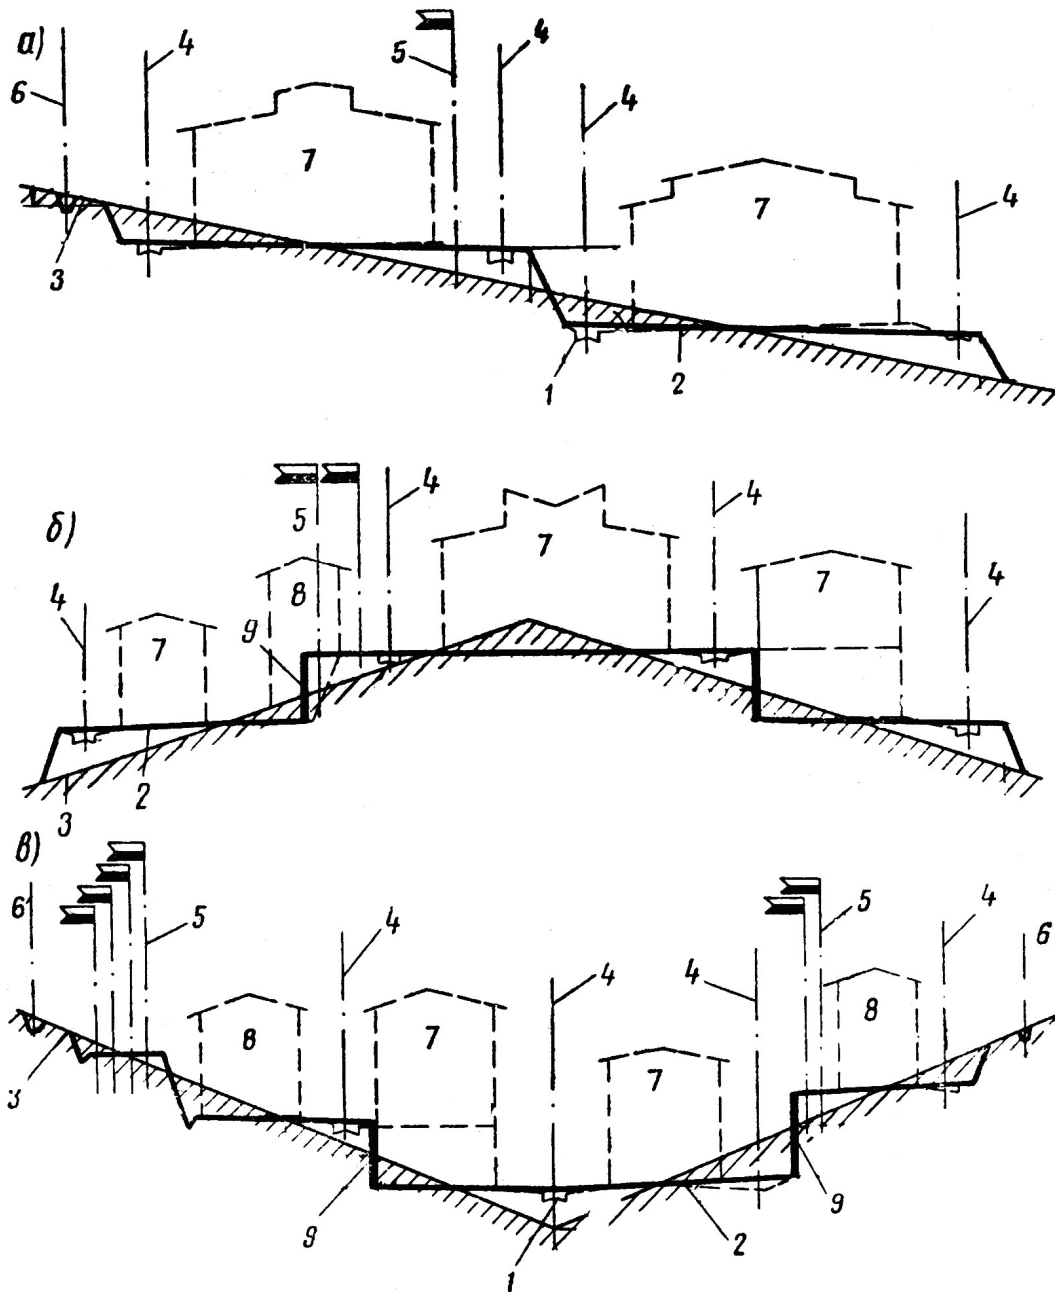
Терасові схеми вертикального планування: а) при ухилі терас в один бік; б) при ухилі терас від середини до меж майданчика; в) при ухилі терас від меж до середини майданчика; 1 – лінія детального планування; 2 – основна планувальна поверхня; 3 – існуючий рельєф; 4 – вісь дороги; 5 – залізниця; 6 – нагірна канава; 7 – цех; 8 – склад; 9 – підпірна стінка
